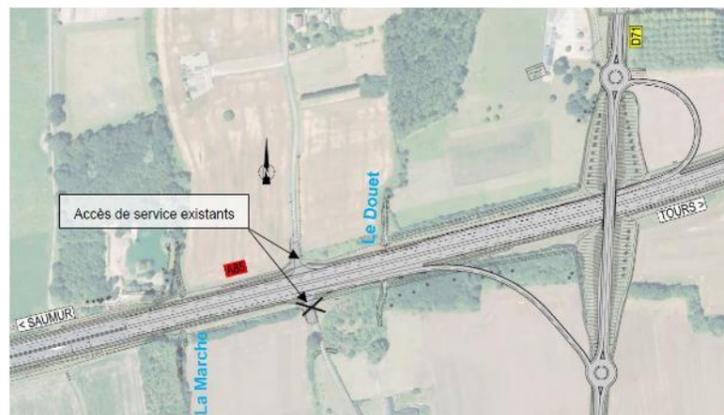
Variante avec entrée en boucle (configuration mixte)
